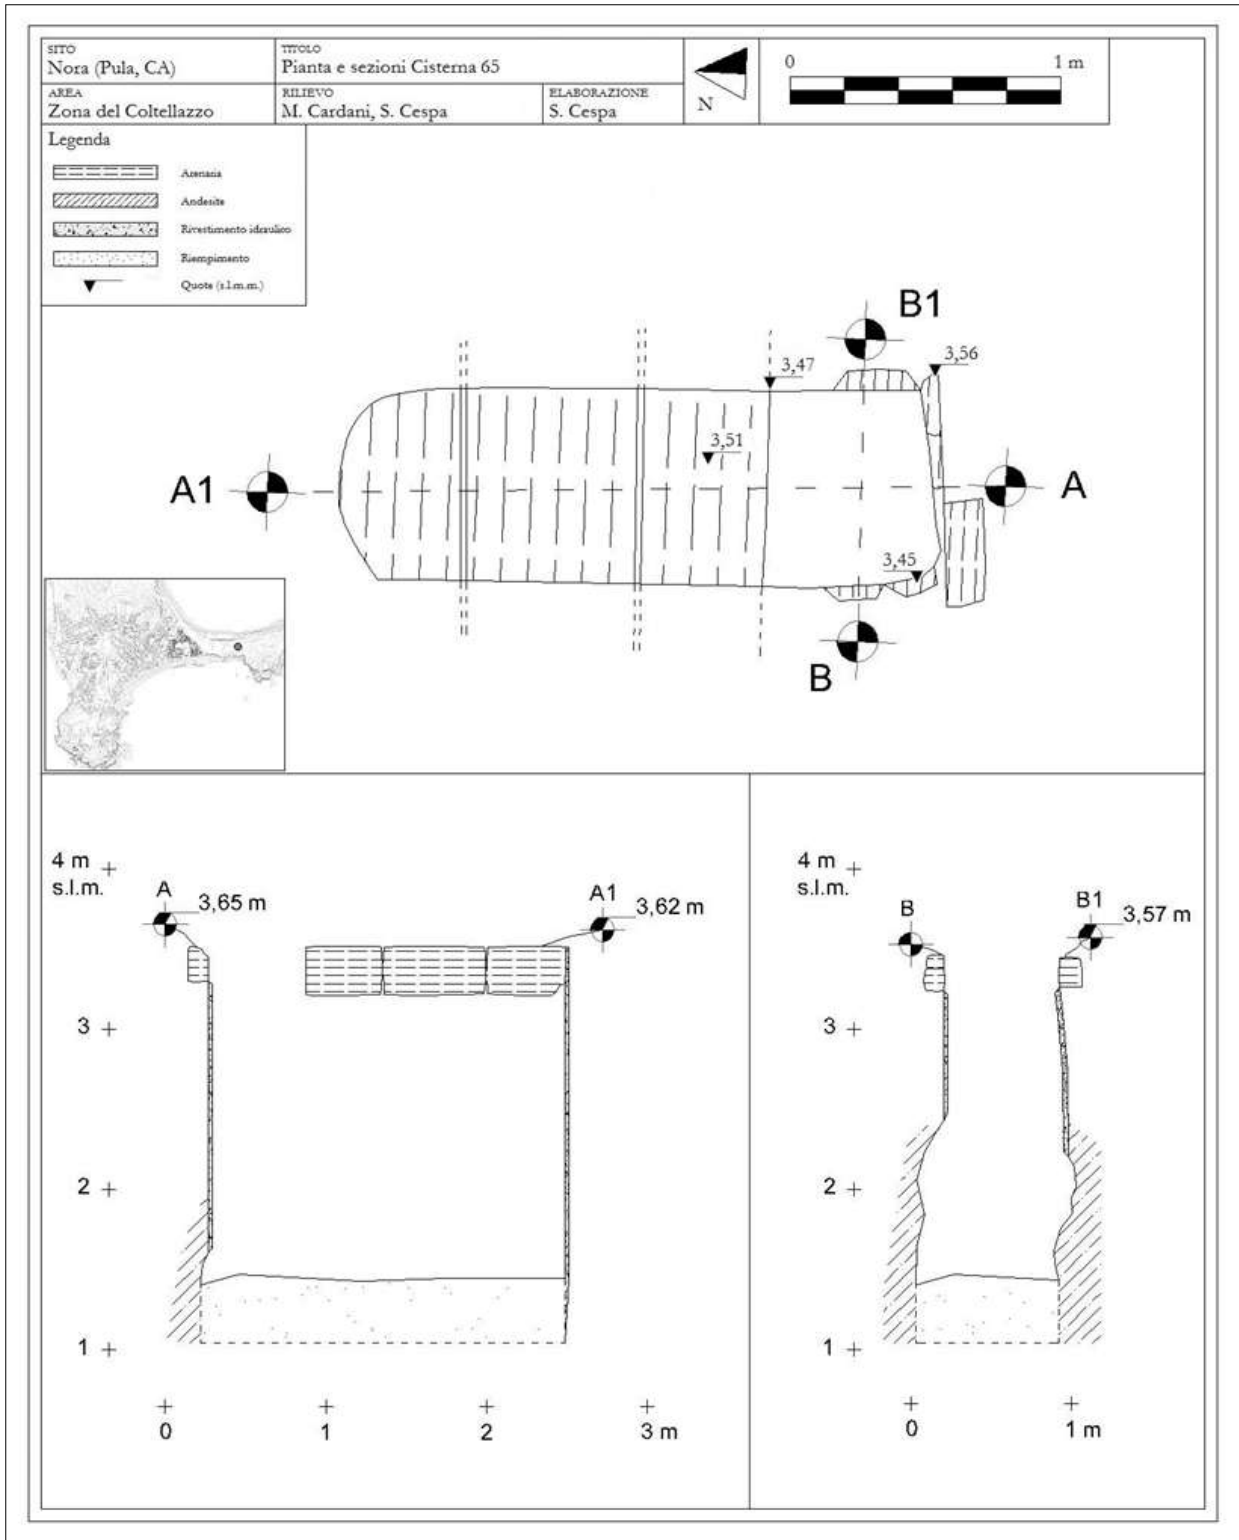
Pianta e sezioni della cisterna 65 (elaborazione dell'autore).
